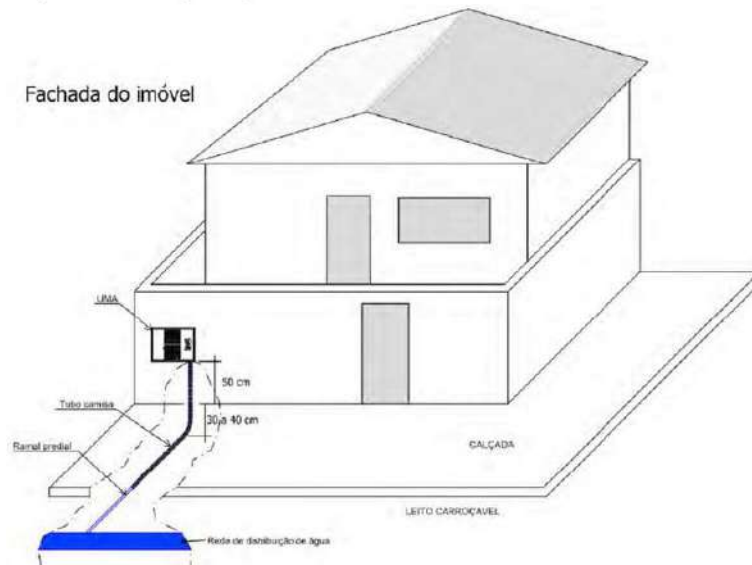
Opções para instalação de caixa em muro lateral – Vista A
